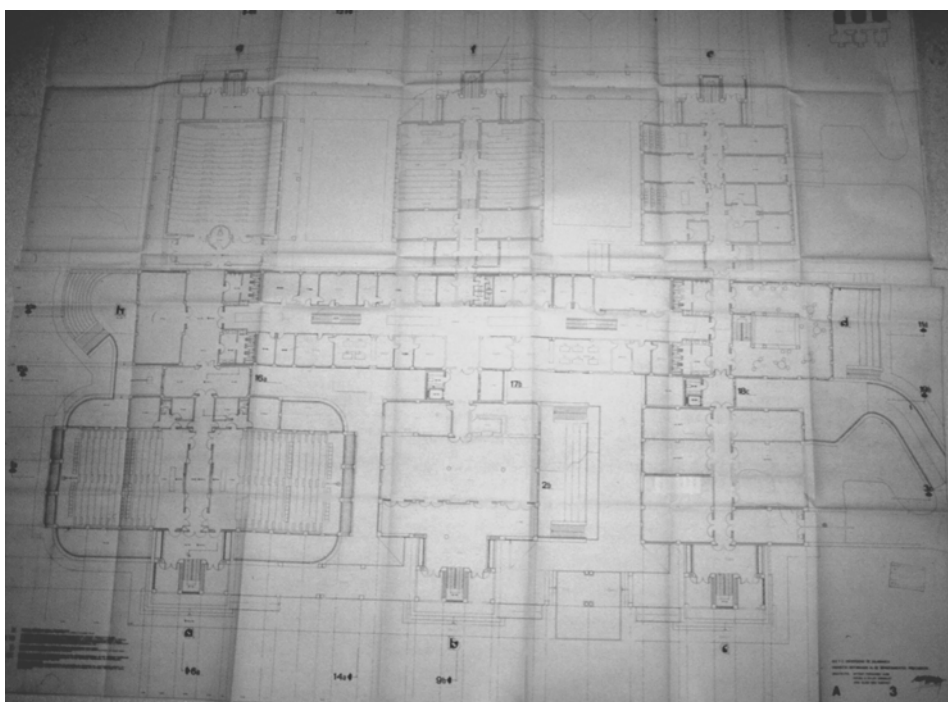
Facultad de Medicina: planta baja, por Antonio Fernández Alba.
